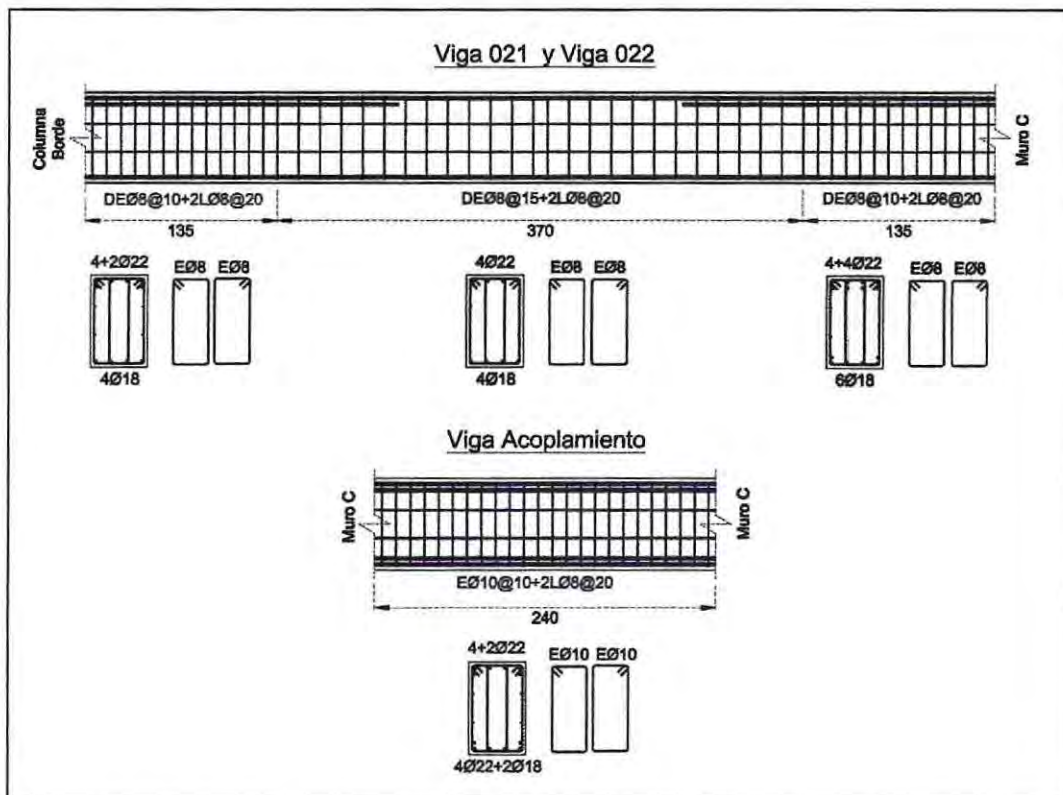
Distribución armadura de corte en vigas Eje B, estructura mixta.
